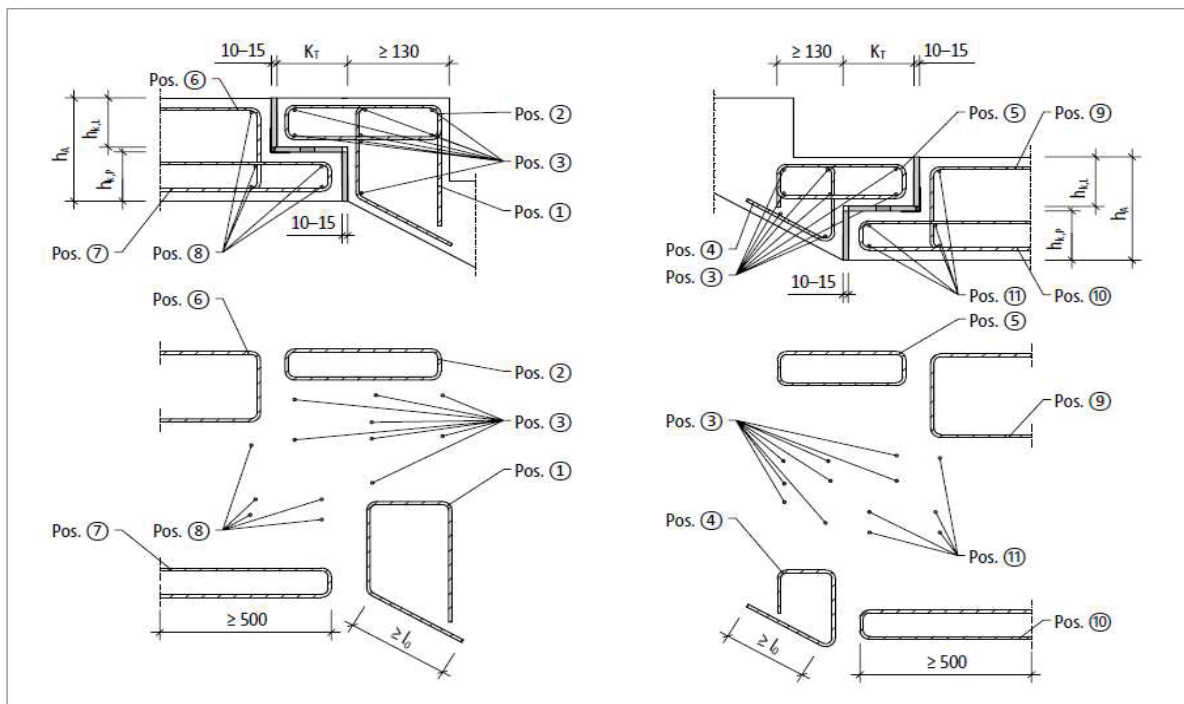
Schöck Tronsole® Typ F: Bauseitige Bewehrung bei bündigem Anschluss
